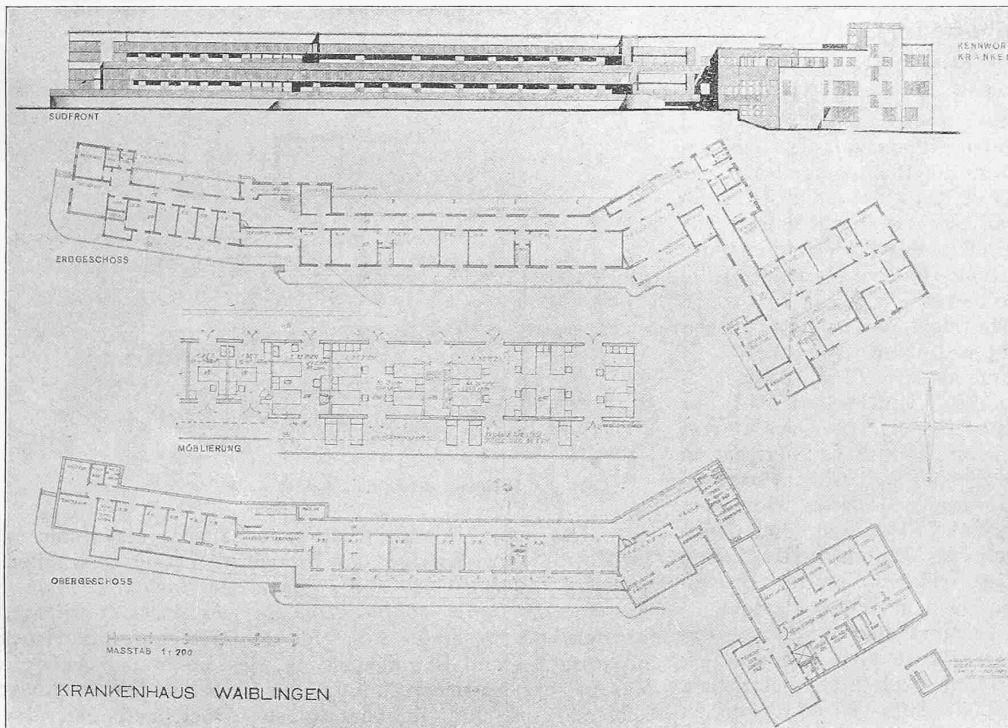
Südfront und Grundrisse des Krankenhauses Waiblingen. — Masstab 1:1000, „Möblierung“ 1:500.
